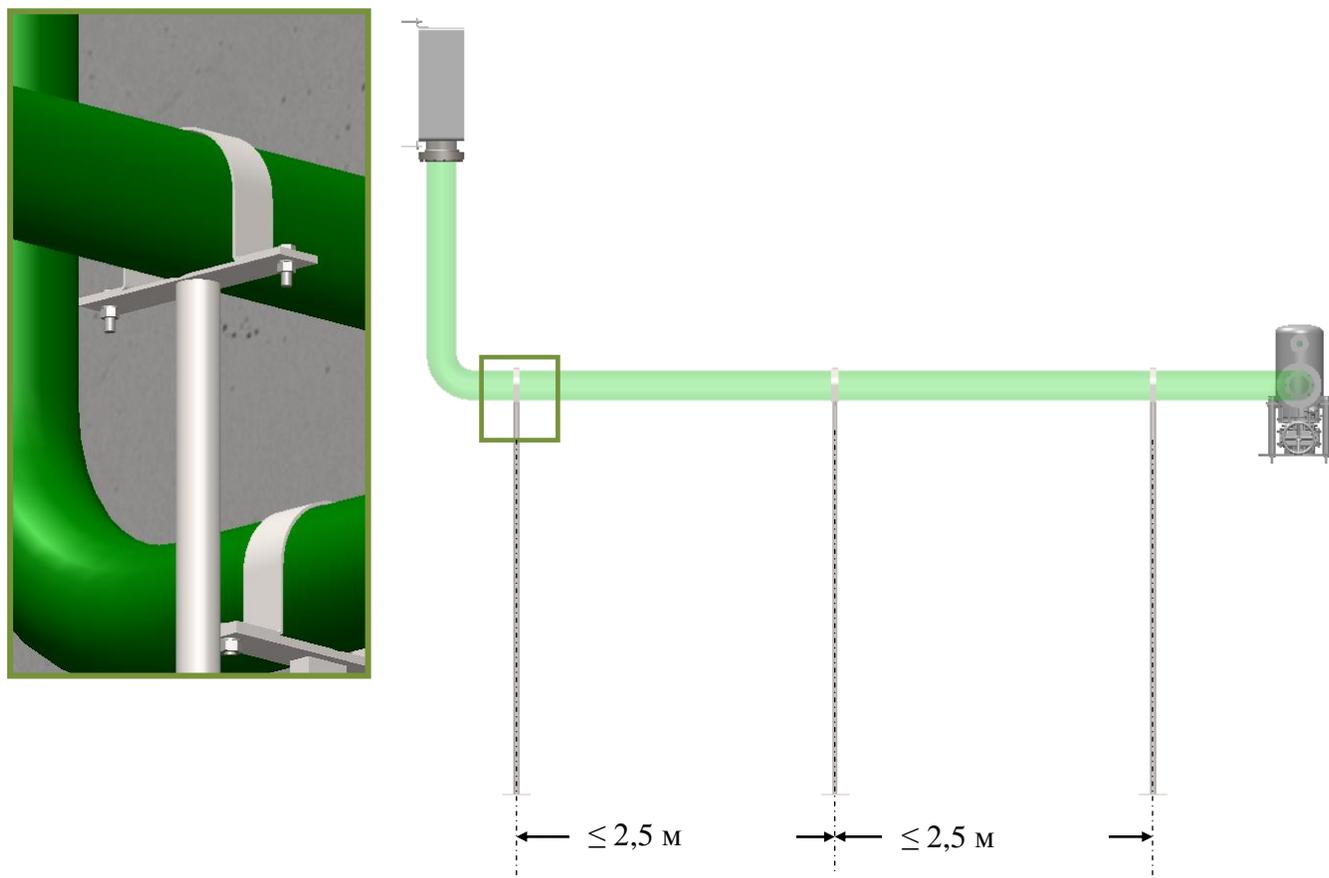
Пример подпорки для трубы слива масла, установка через каждые 2,5 м
